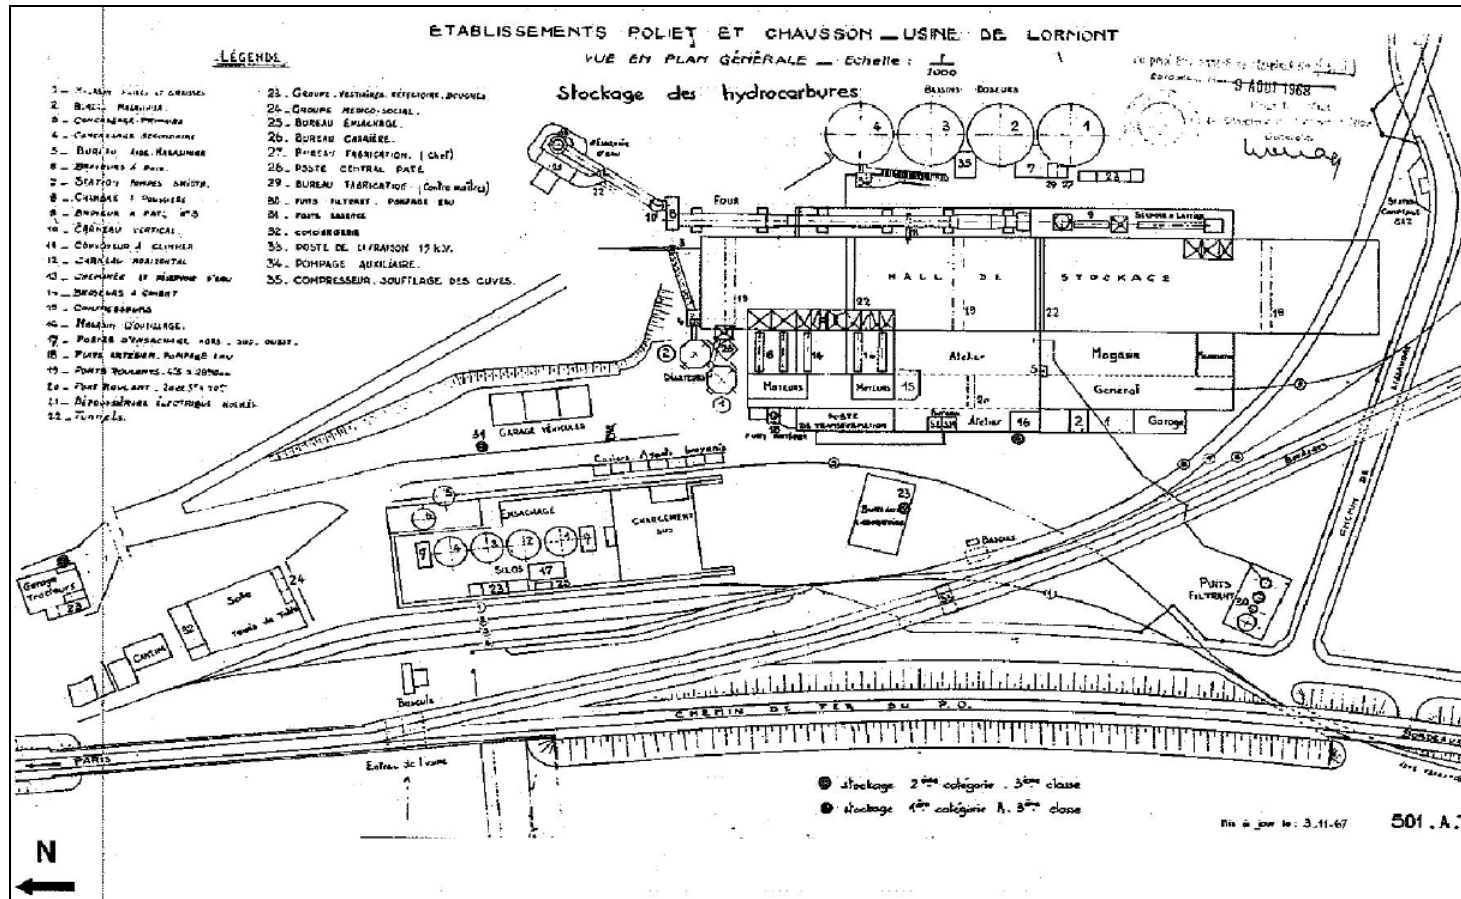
Plan de l'ancienne cimenterie Poliet et Chausson en 1967
